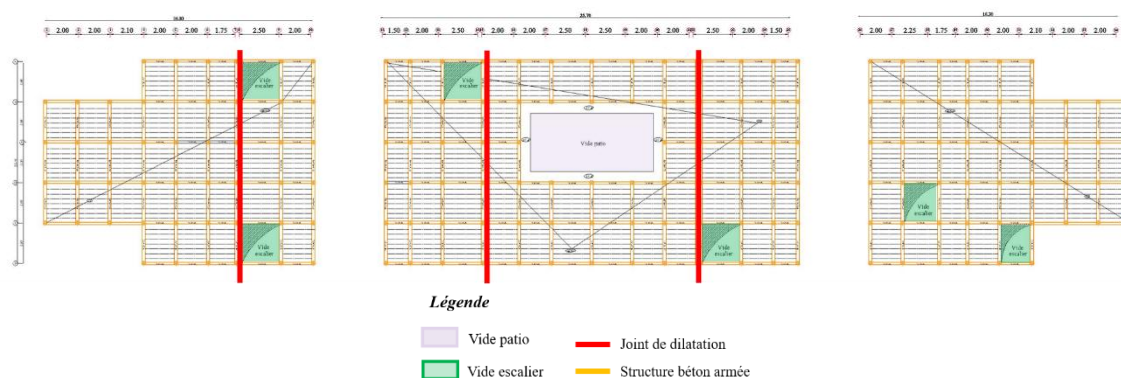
Coffrage plancher (Niveau +5.95)
